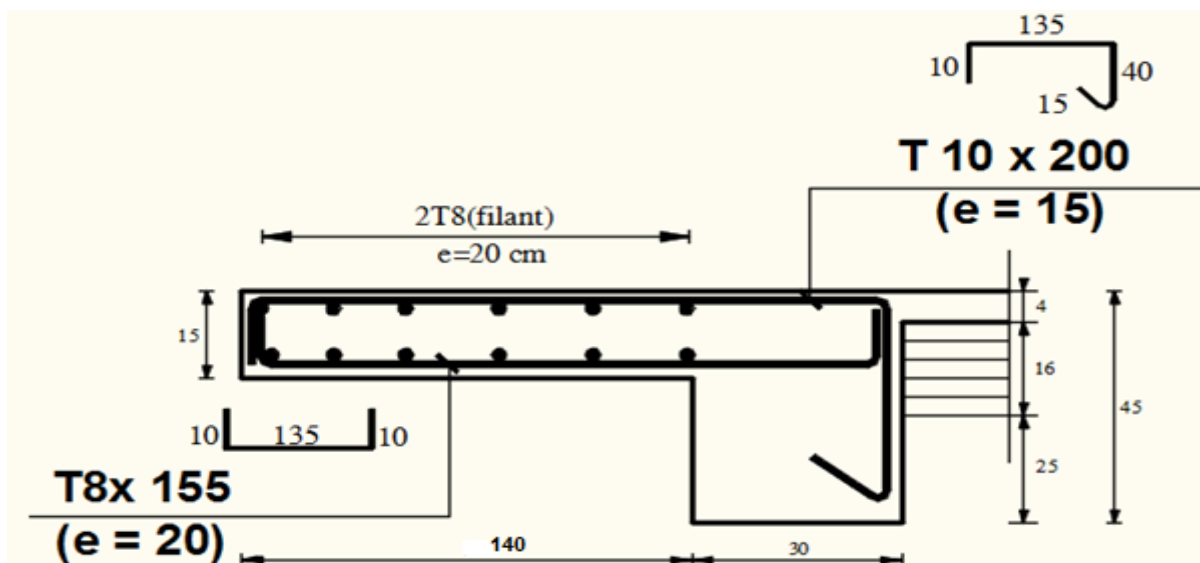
Schéma de ferrailage balcon type 1.
